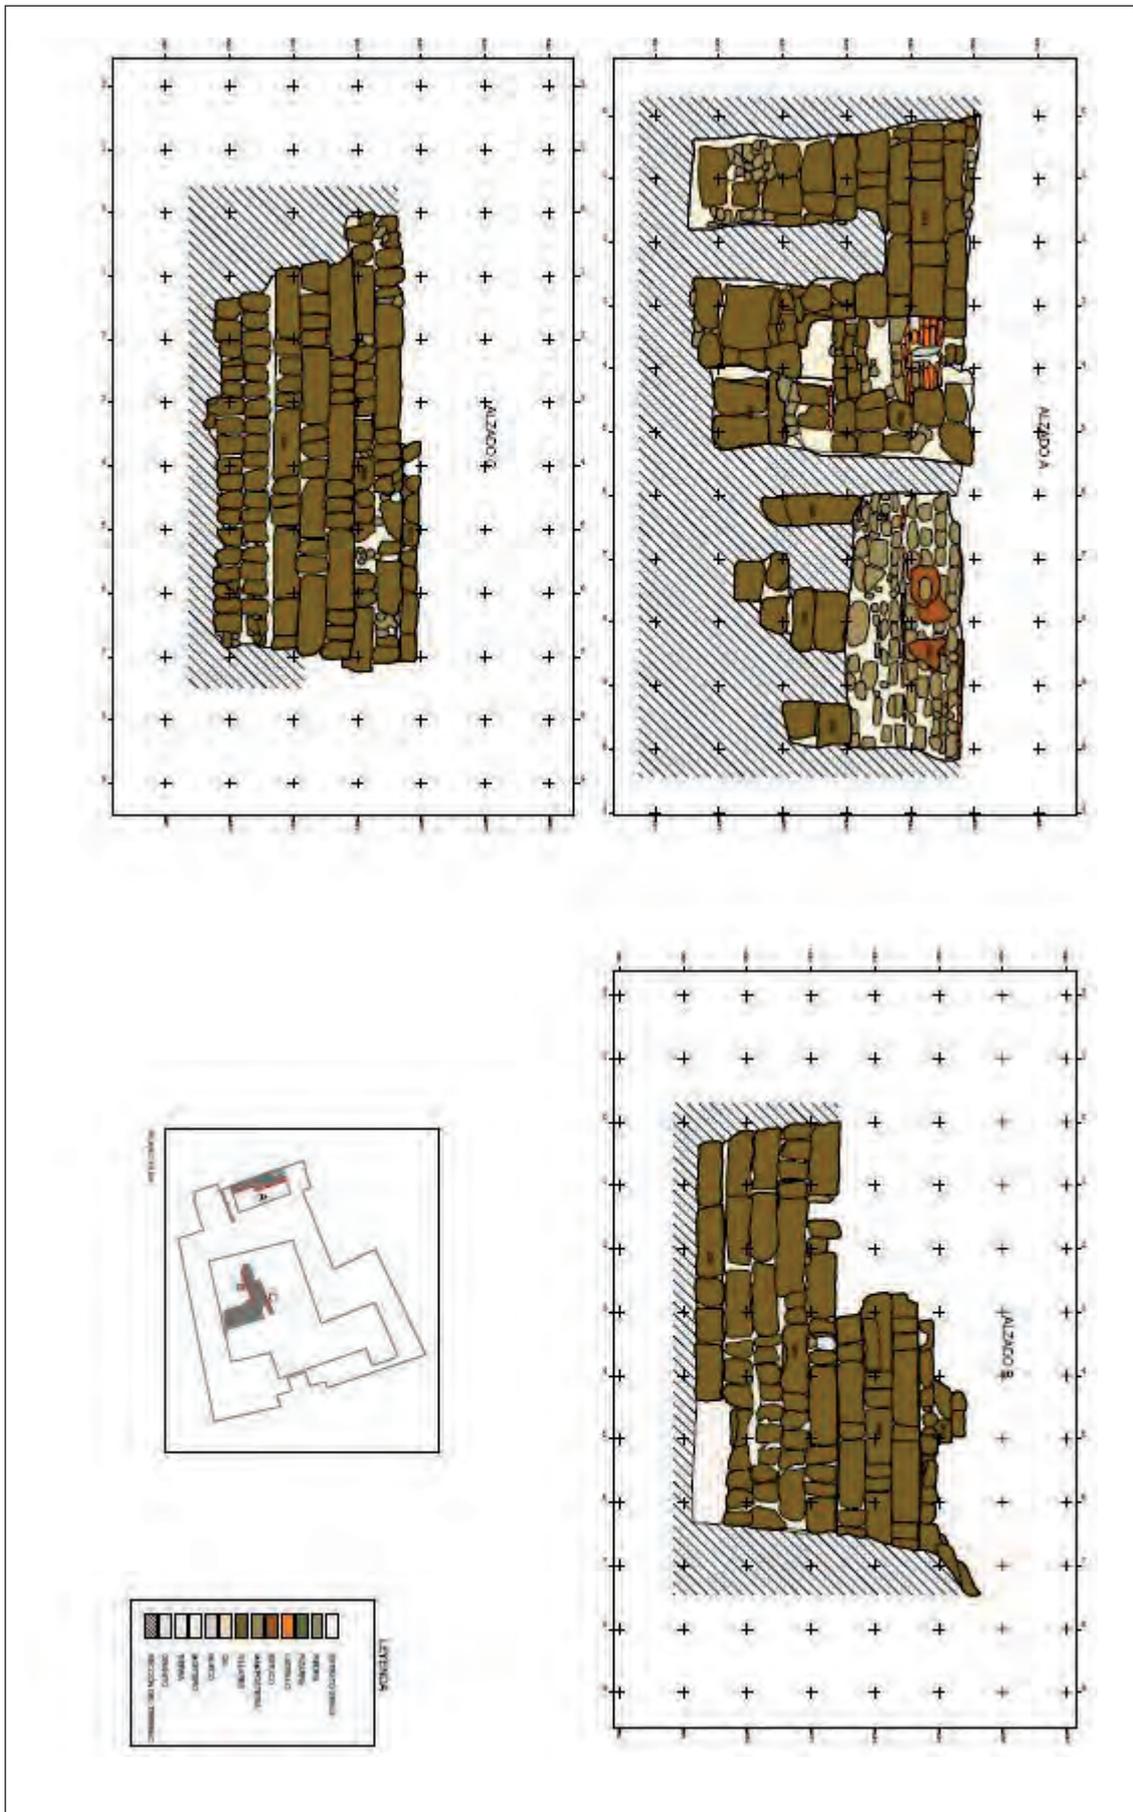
Dibujo planimétrico de los alzados de las murallas.
